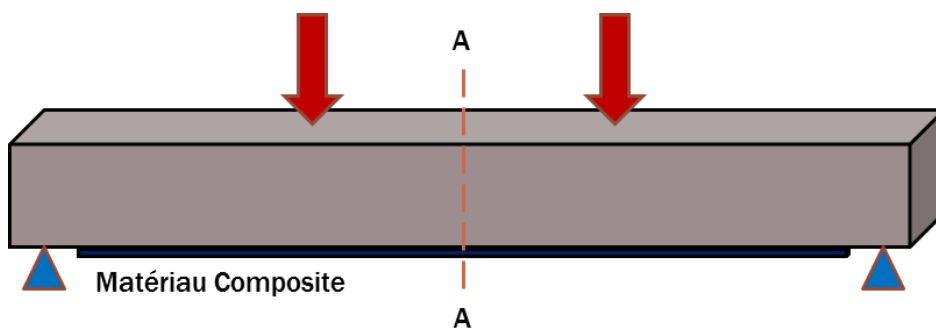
Configuration d'une poutre en béton armé soumise à la flexion
